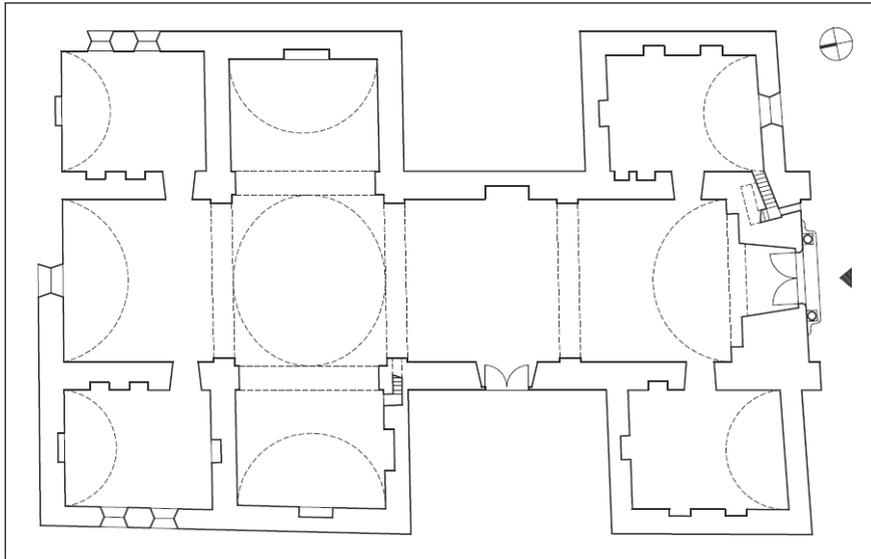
Plano de planta del Templo de San Bernardo (fuente: Potosí Bolivia: Guía de arquitectura 2004: 160).
